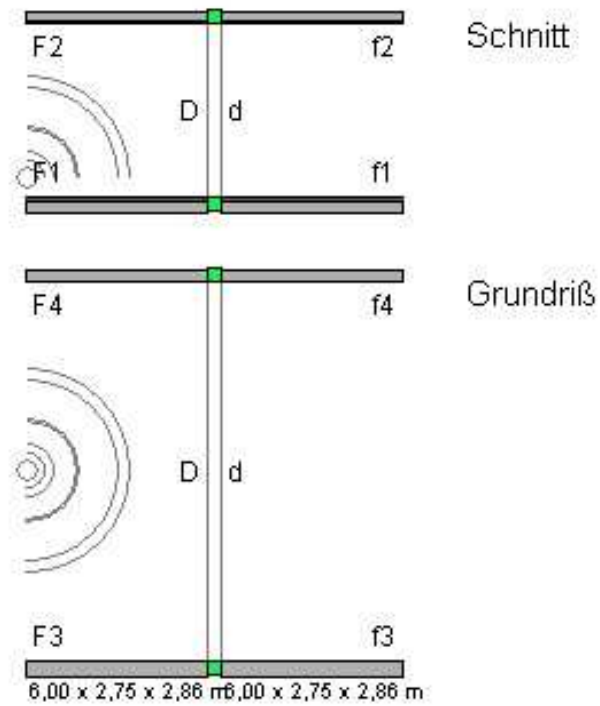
Raumgeometrien des Empfangs- und Senderraums Bauteil B
